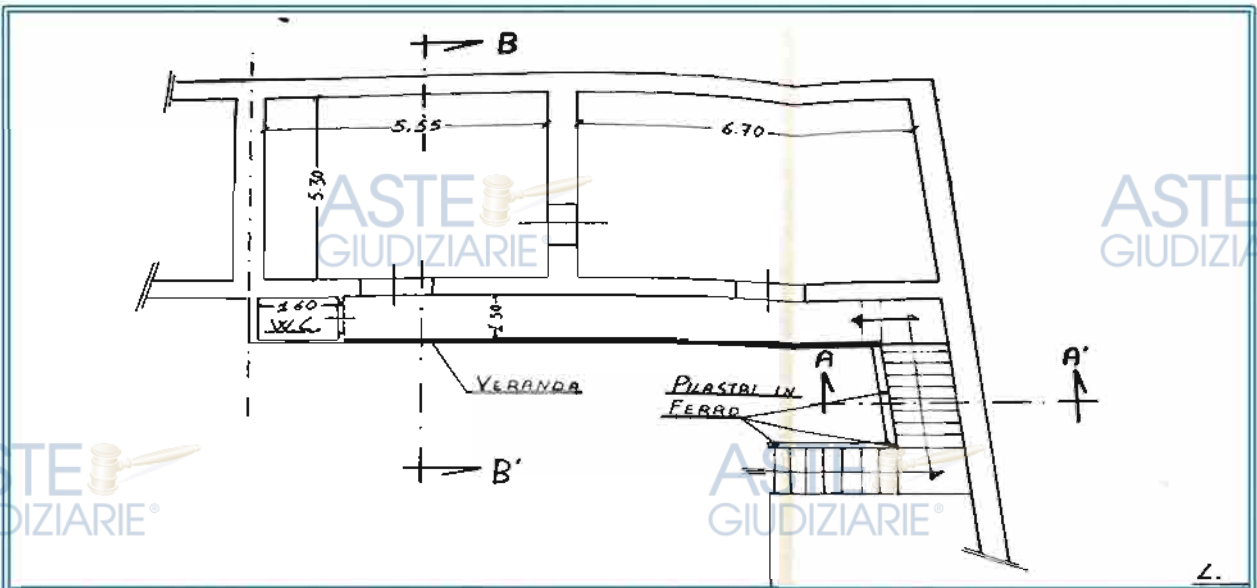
Pianta piano primo (post operam) – estratto dal fascicolo pratica di costruzione edile n. 5951 del 17.03.1988
